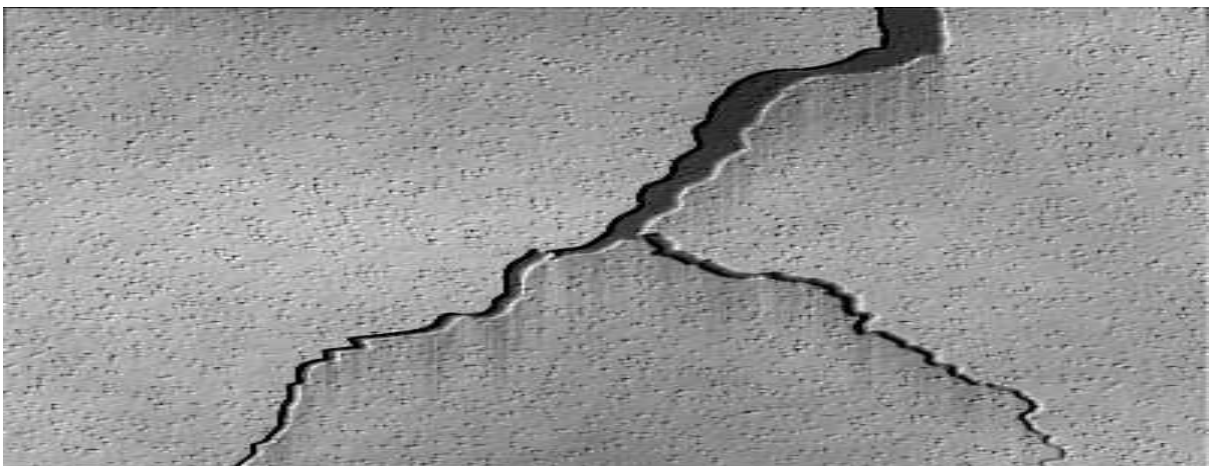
Fissura [fonte: José Castro(2006)]
